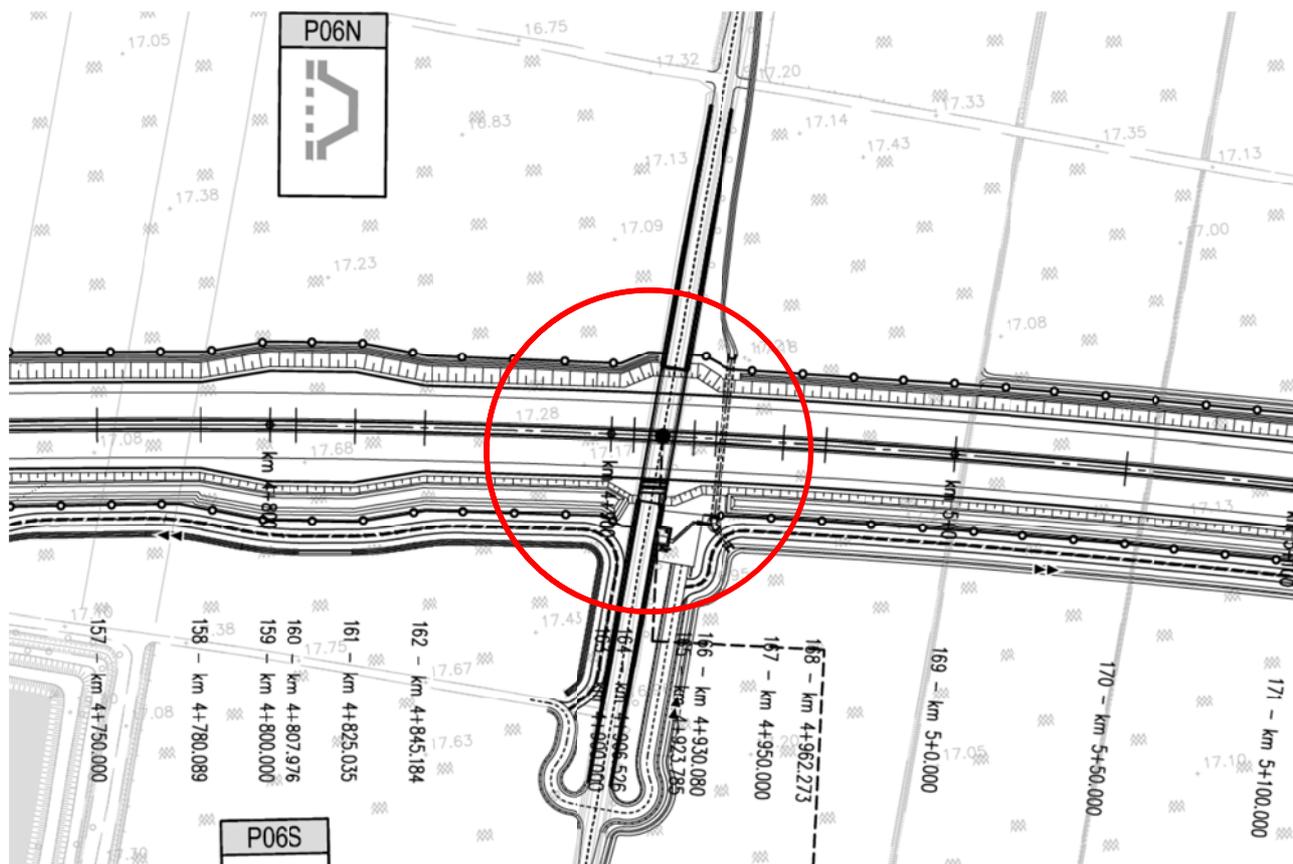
ESEMPIO ALLARGAMENTO RILEVATO IN CORRISPONDENZA SOTTOVIA
